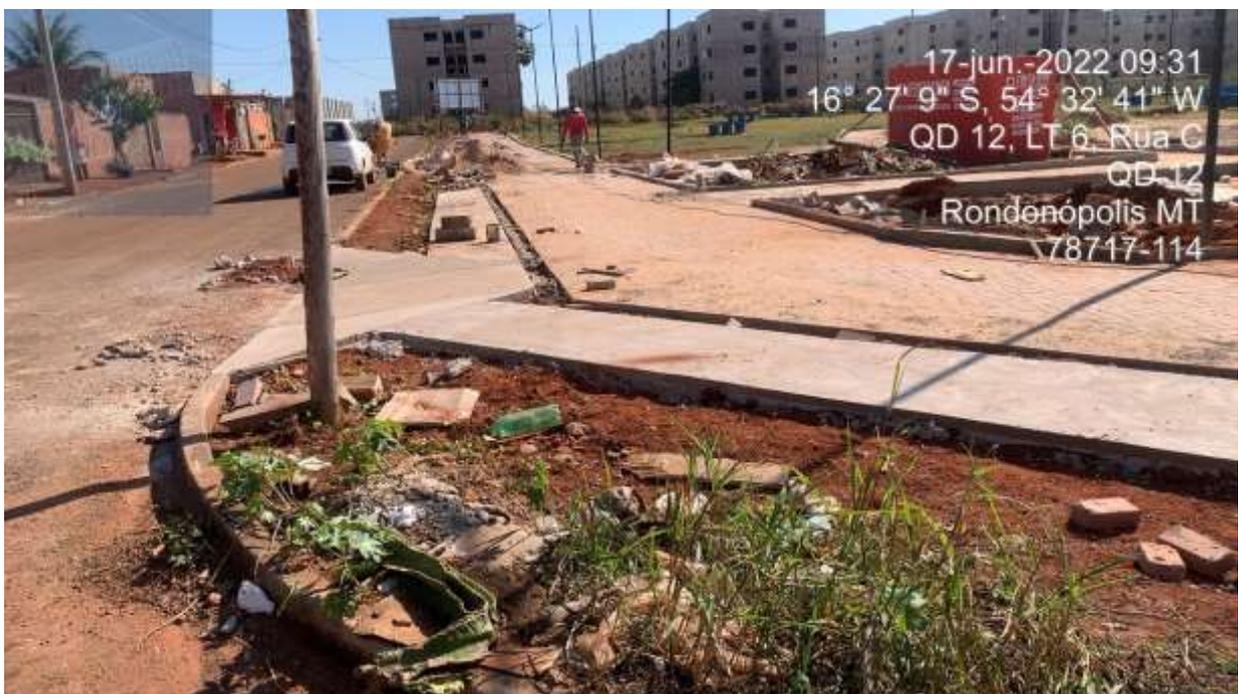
Falta instalação do piso tátil nas calçadas externas.
